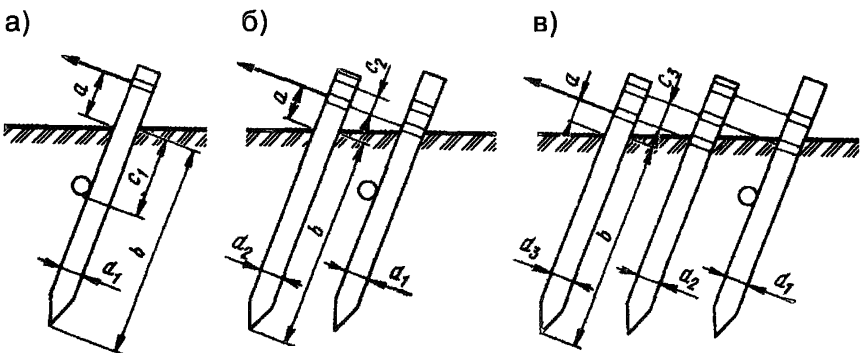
Схемы конструкций свайных опор с указанием линейных размеров:
